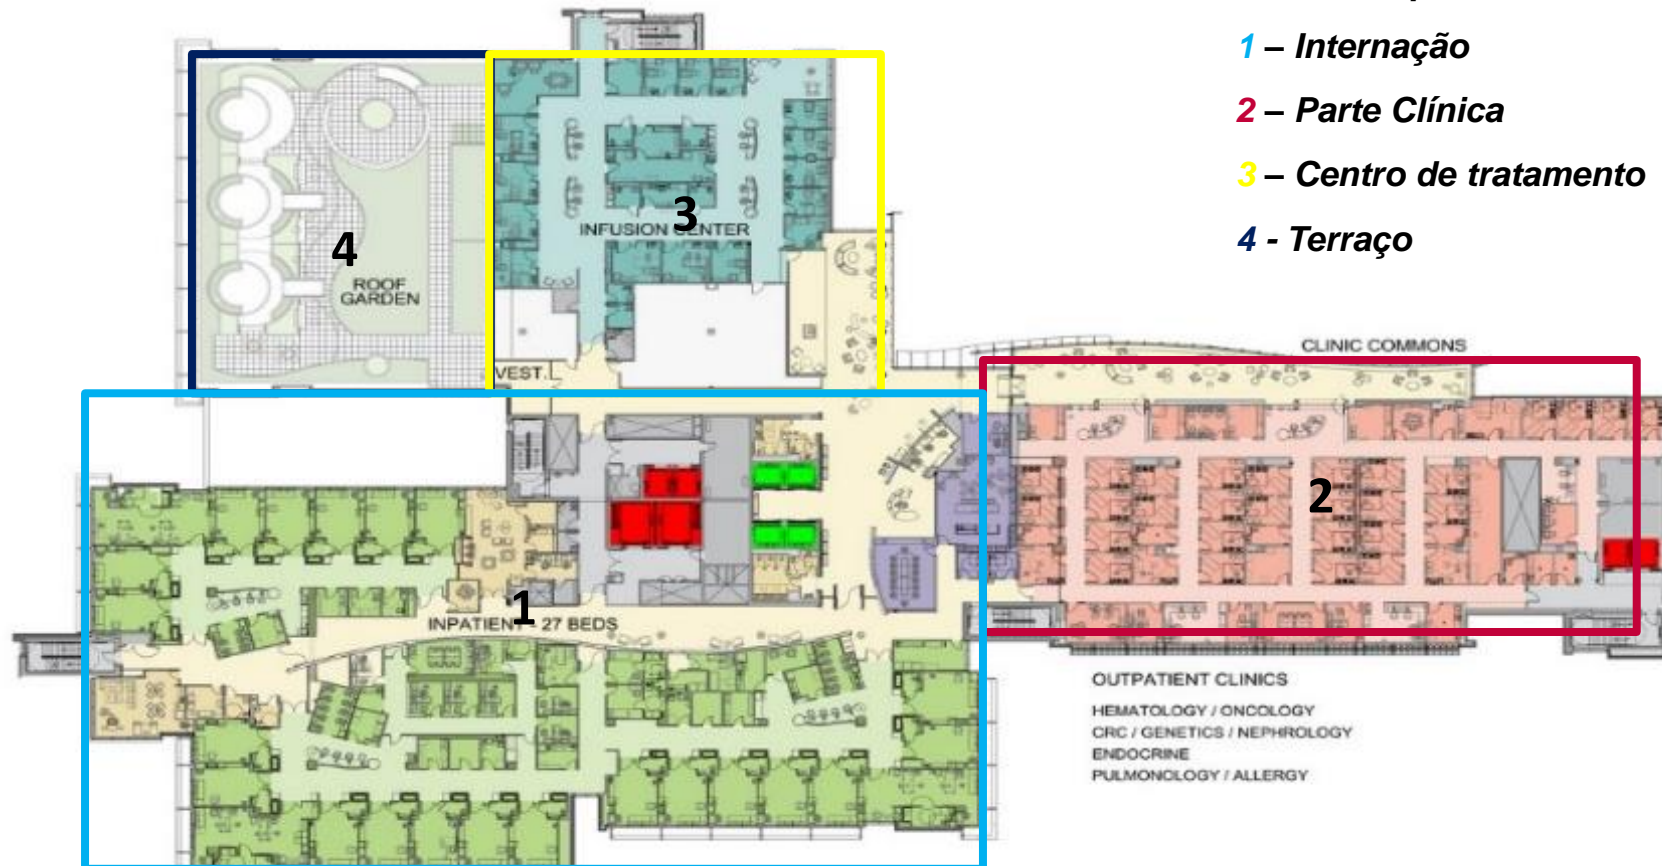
Planta baixa do Edifício Nemours – Primeiro Terceiro
